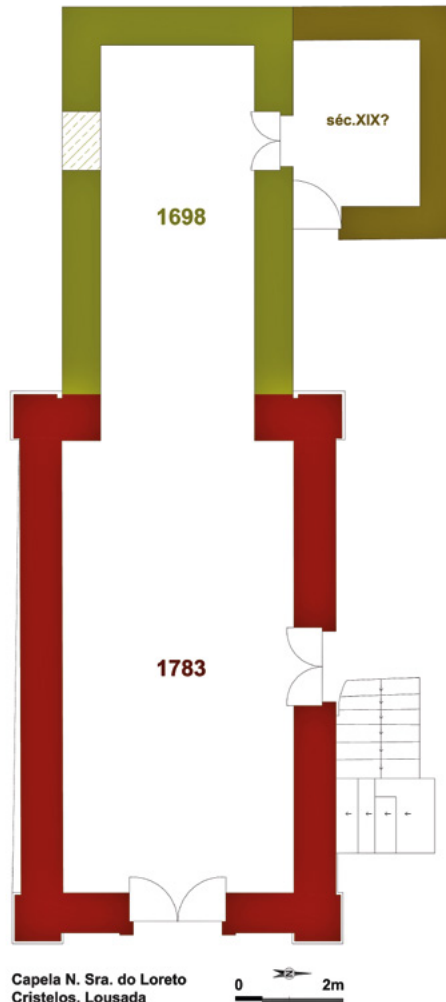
Planta da capela de N. Sr.^a do Loreto.
